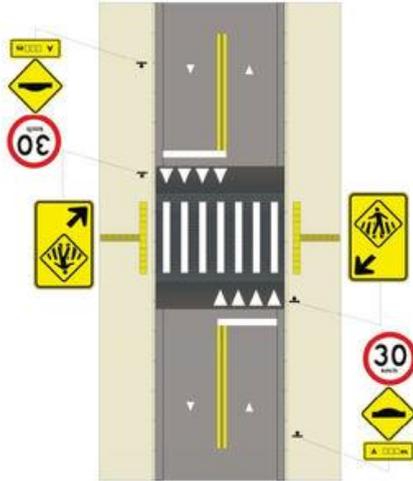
Sinalização horizontal e vertical para travessia elevada de pedestres.
